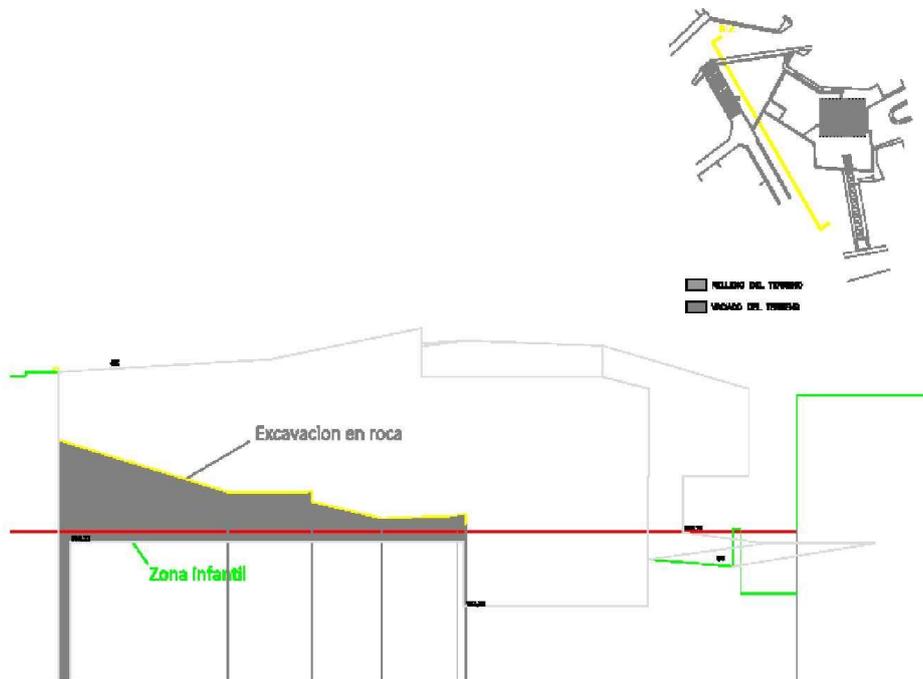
Se observa que la zona afectada está ubicado en un terreno excavado en la roca.
